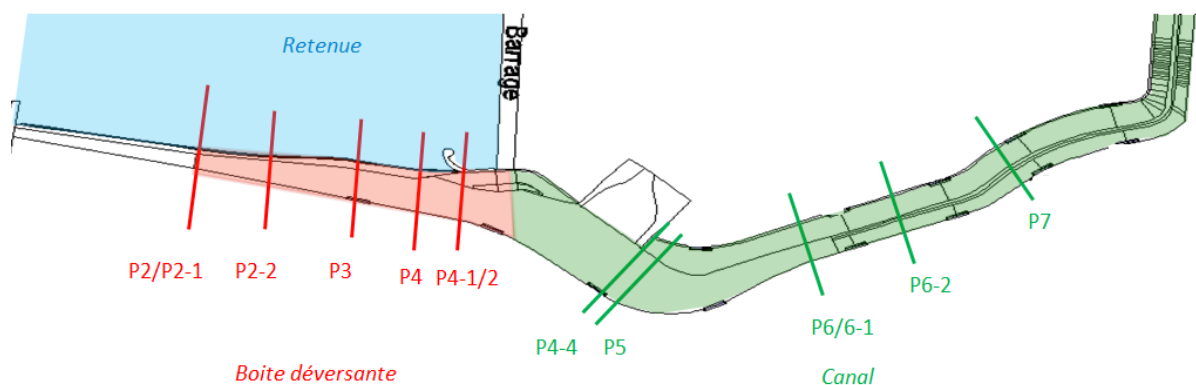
Vue en plan de principe et implantation des principaux profils de calcul
